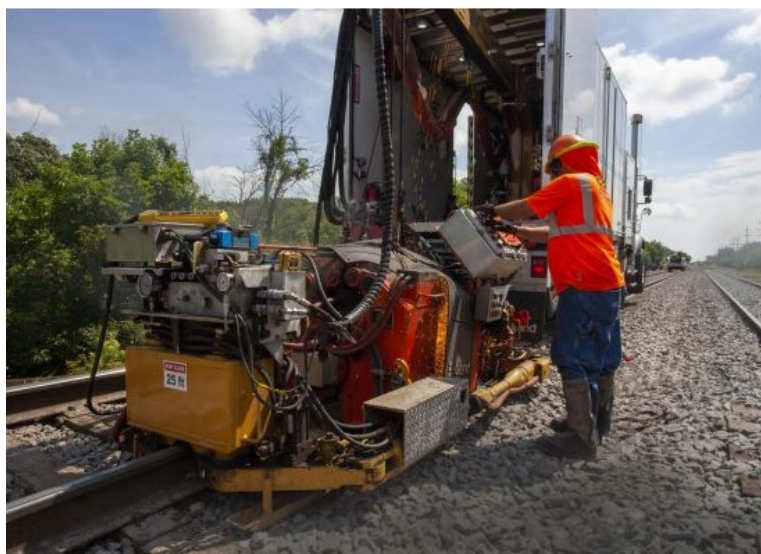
Сварка встык с помощью Puller Lite
